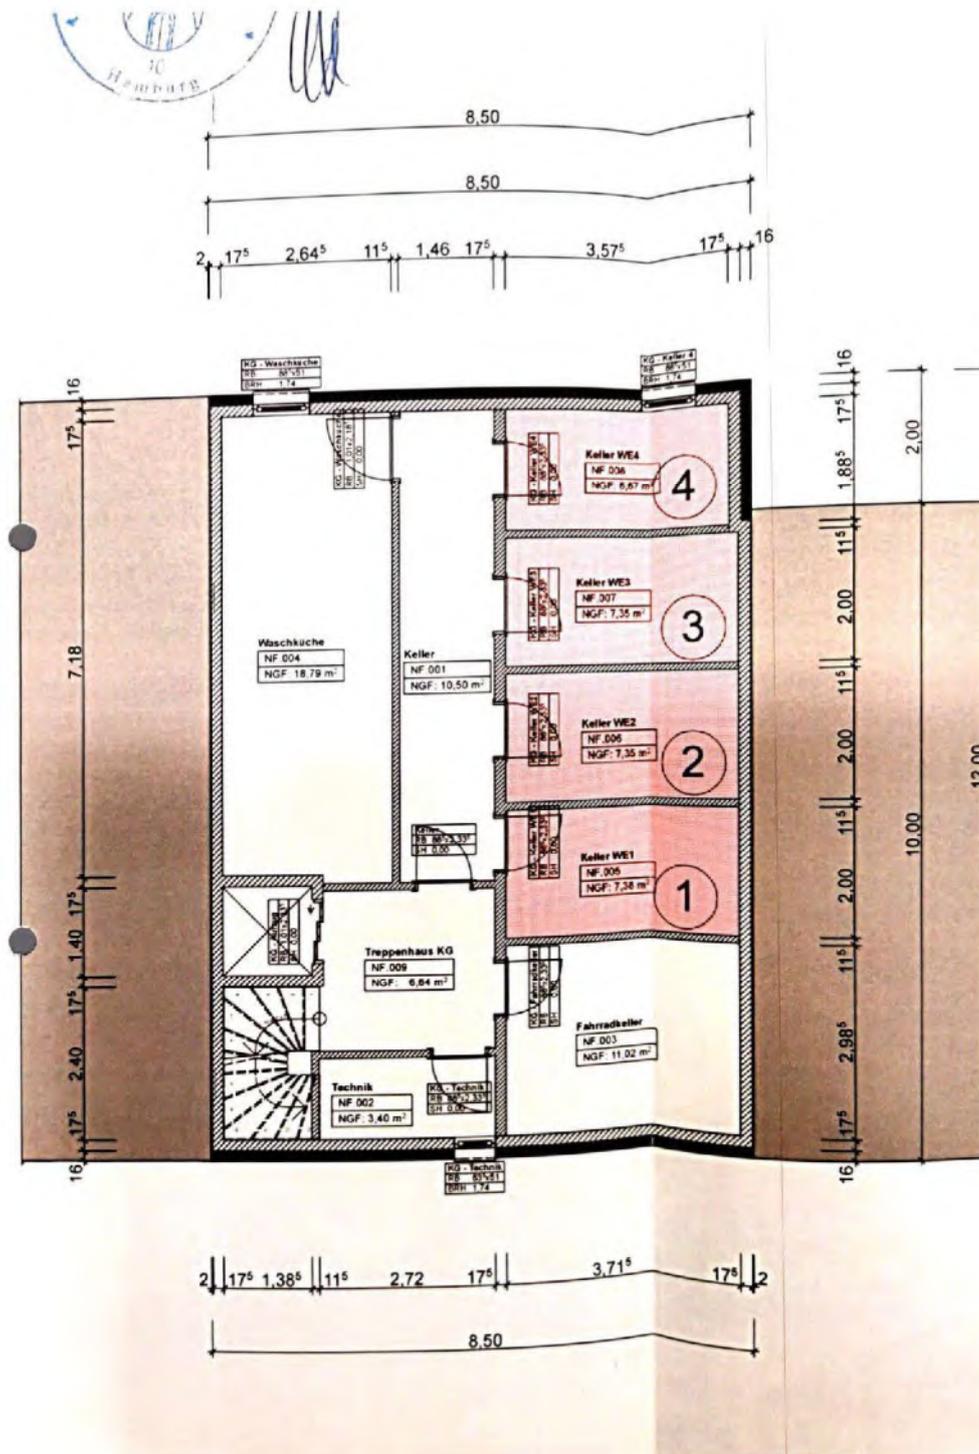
Grundriss KG mit Keller Nr. 3
